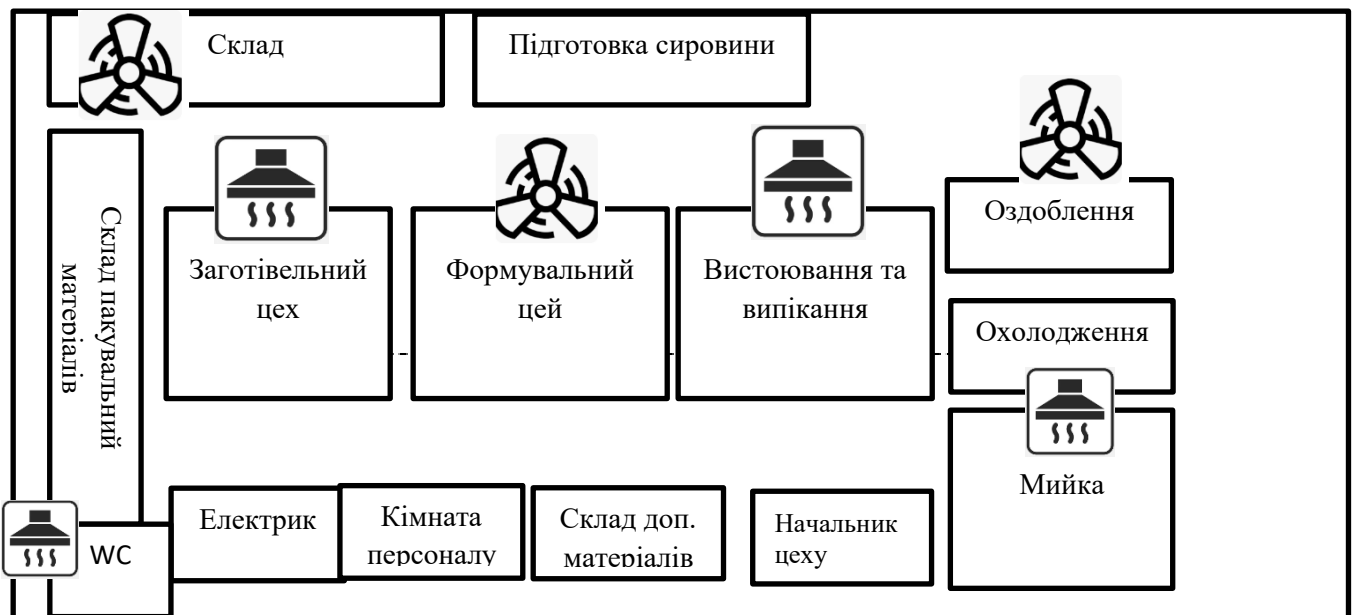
Схема вентиляції у пекарні «Pan Baker»
